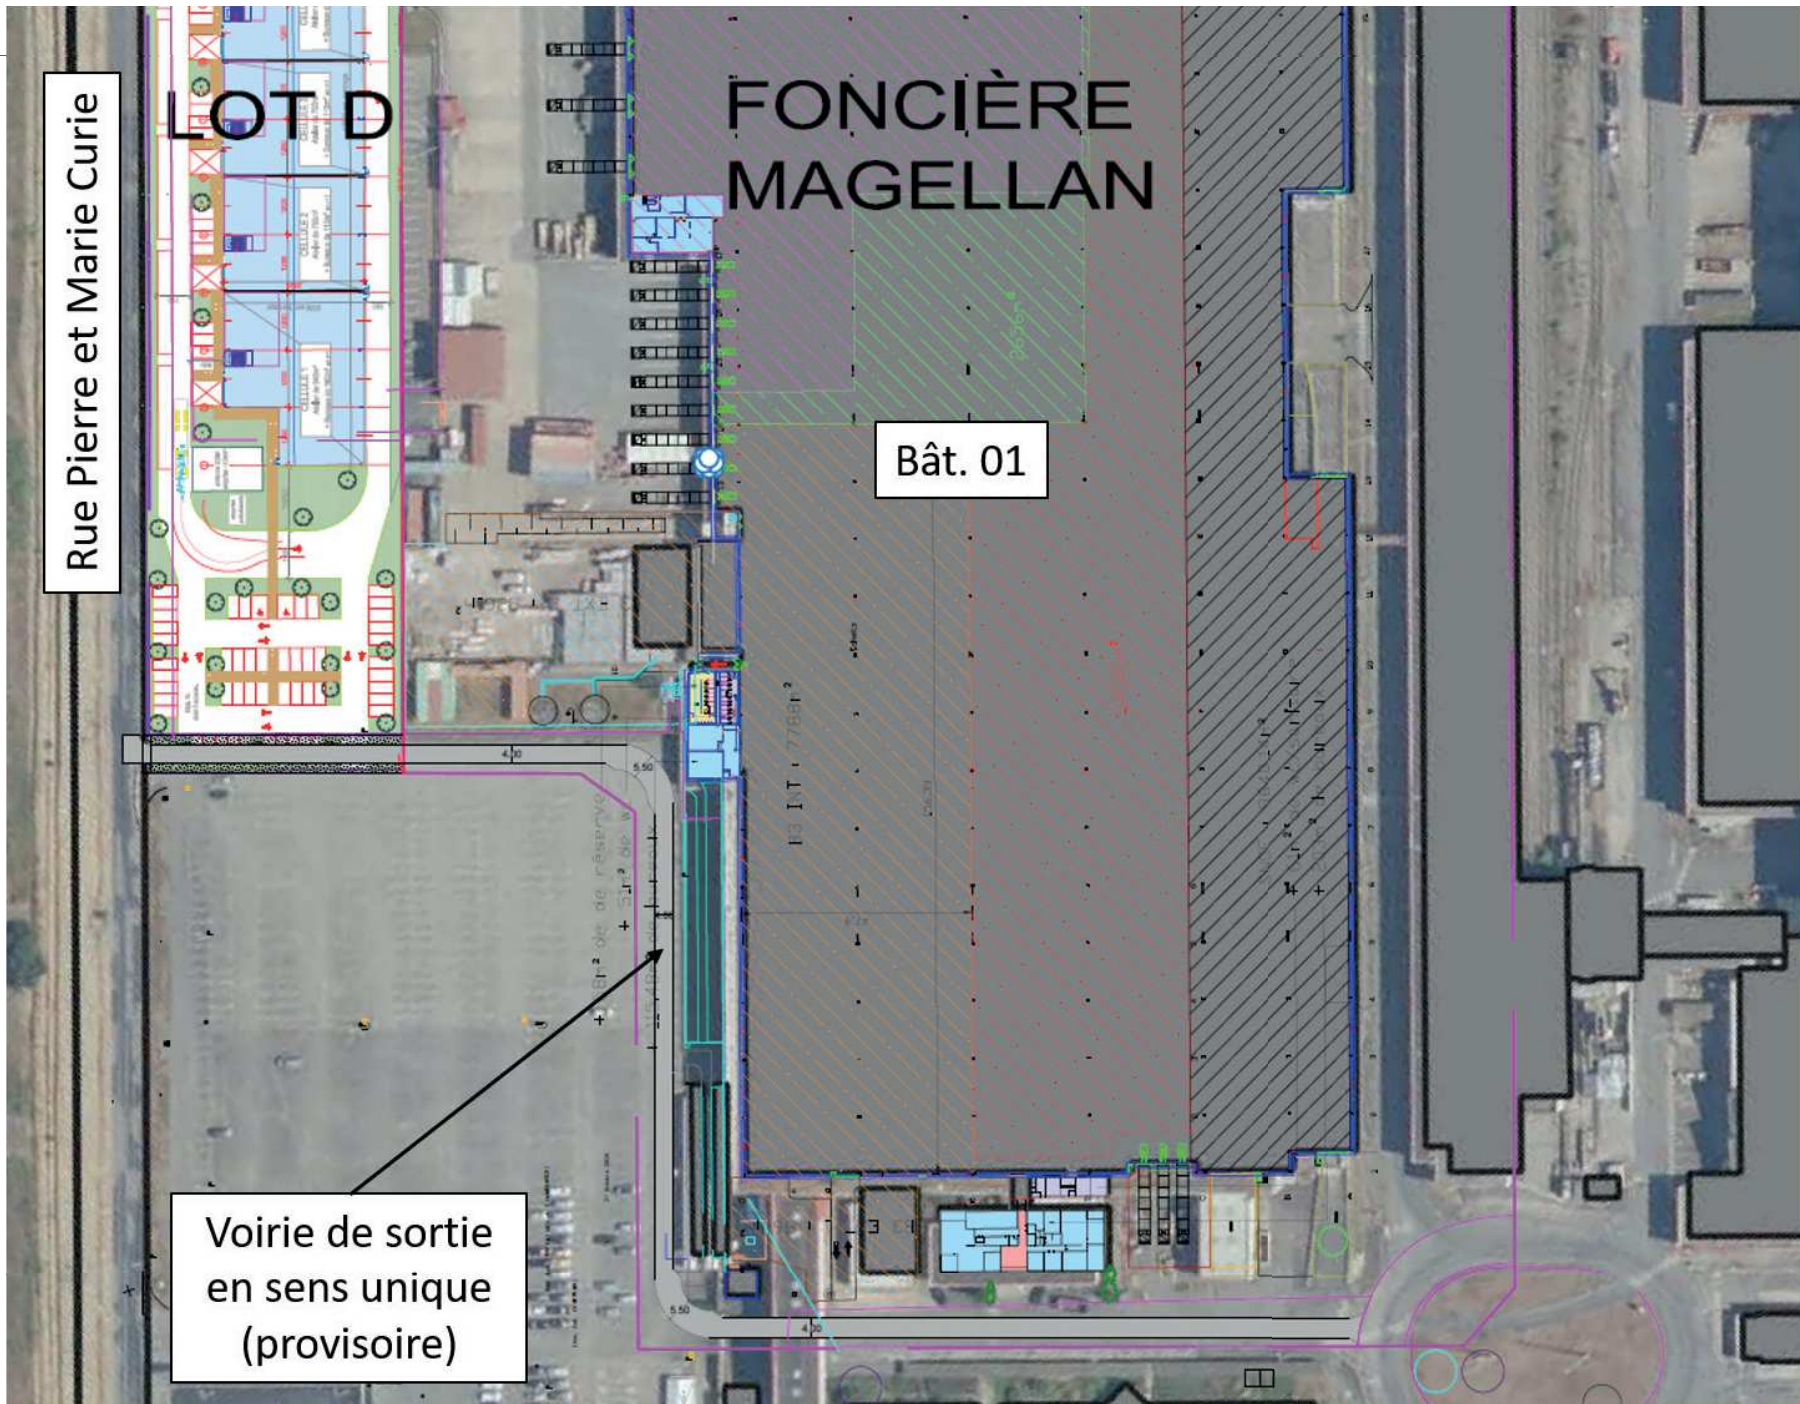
Plan masse du projet - Zoom sur la sortie sud
